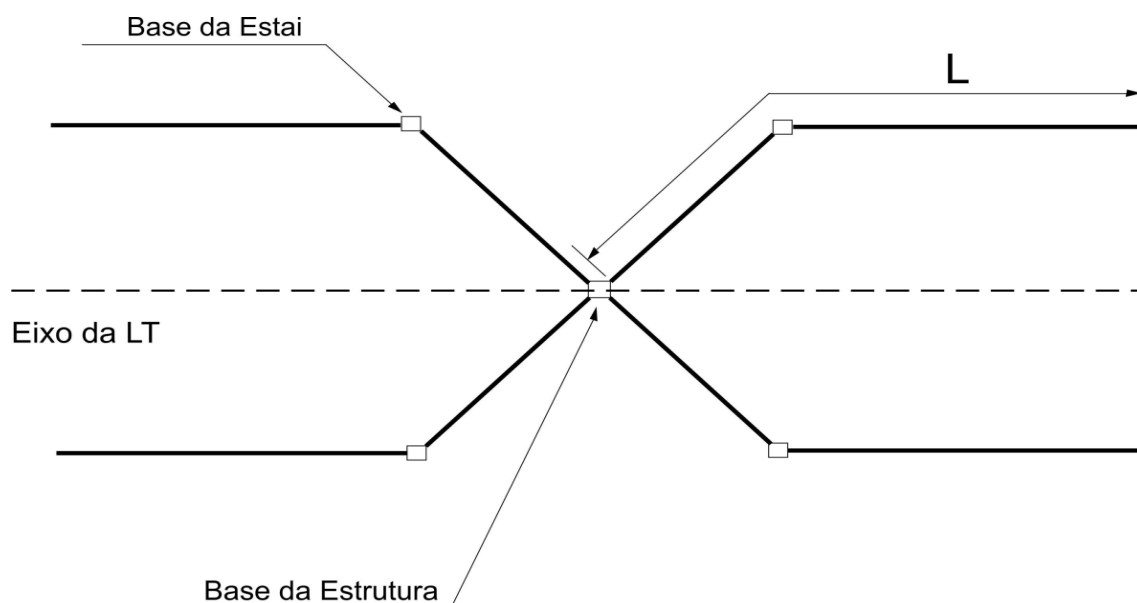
Aterramento de Estruturas Estaiadas
